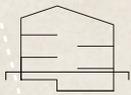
Grundriss: Zone II: 2.OG. M 1:400
